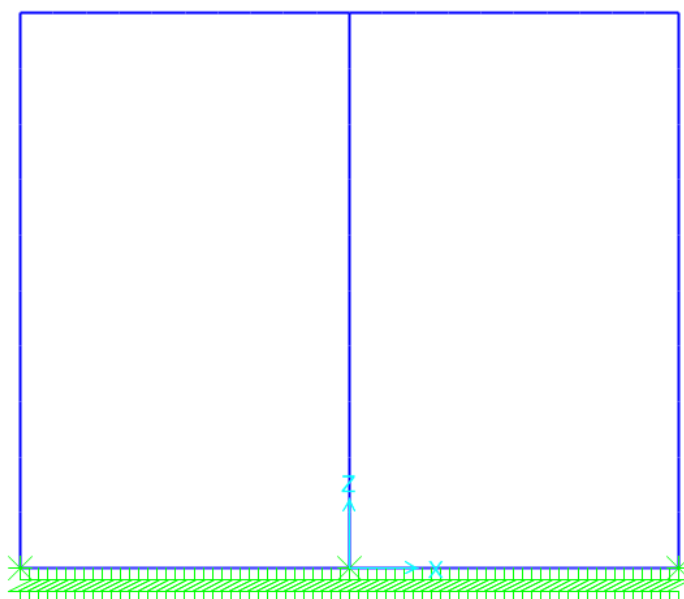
Modellazione in SAP2000 della sezione trasversale tipo
